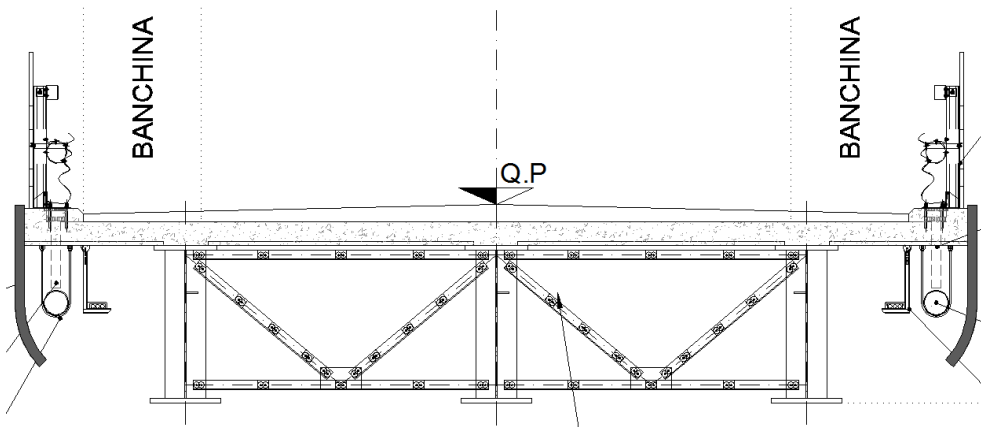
Sezione trasversale dell'impalcato campata centrale
